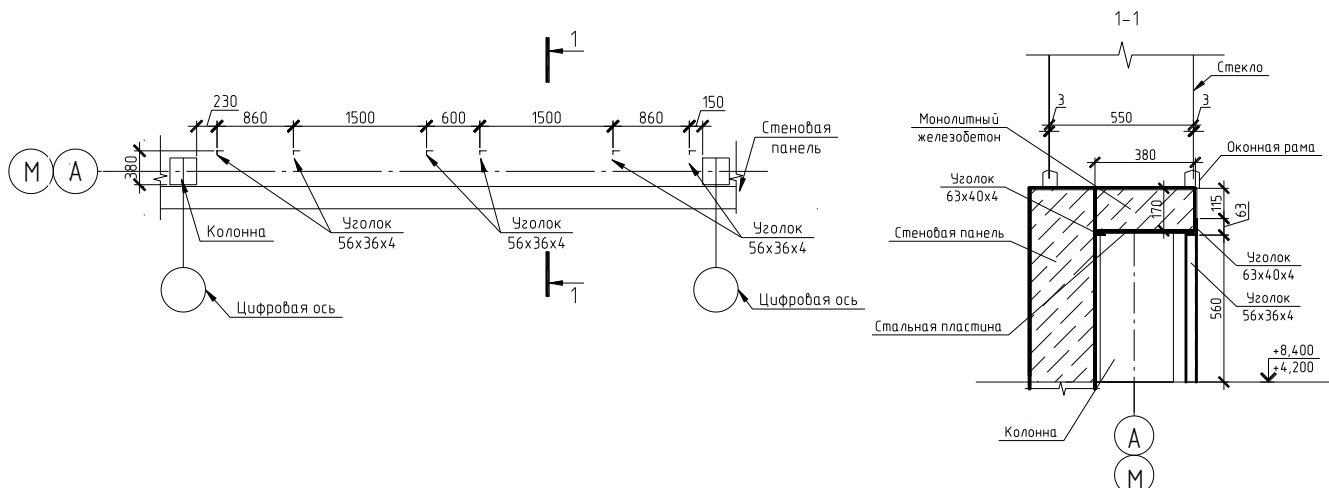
Схема размещения конструктивных элементов под оконными проемами, располагаемые по оси А и М
